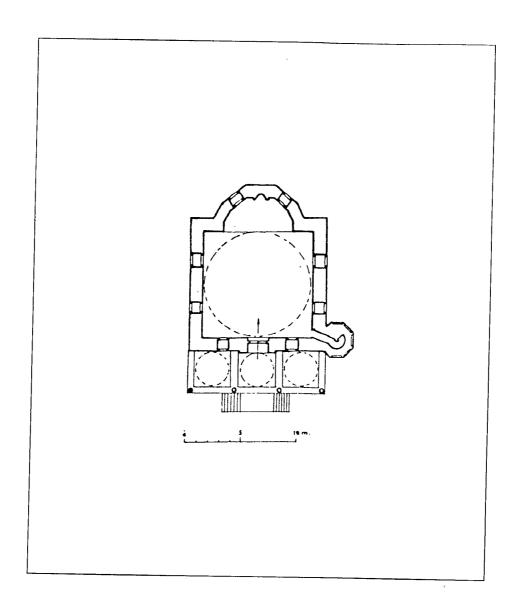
مسقط أفقي لمسجد Hadun في ياكوفكا (عن :Pašić) .
